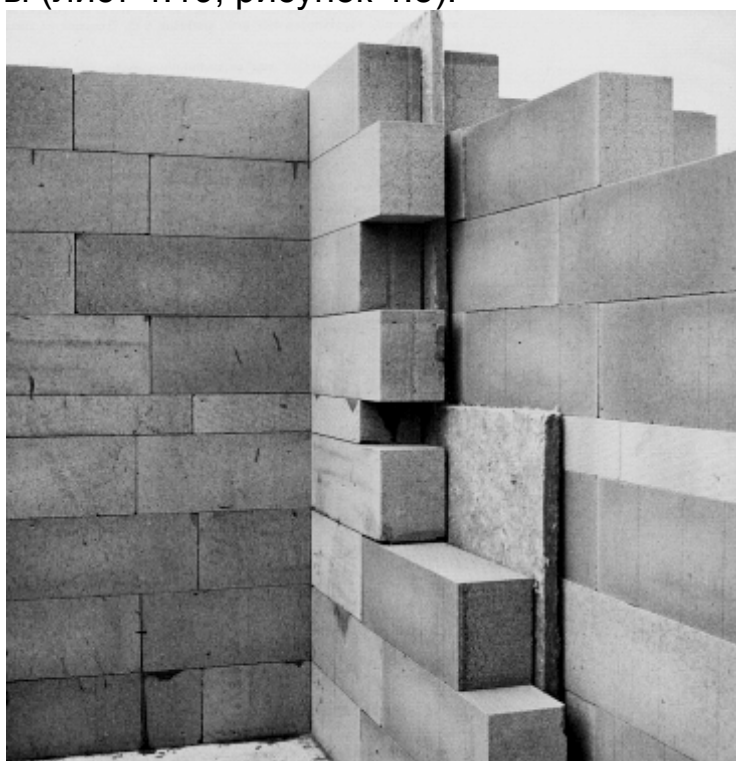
Монтаж межсекционной внутренней несущей стены из газобетонных камней на клею с минераловатным вкладышем в зоне примыкания перегородки из газобетонных блоков
